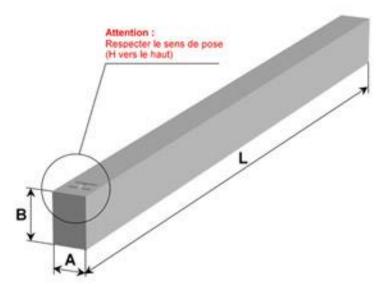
Schéma de poutre L / 15 \leq h_t \leq L /10
